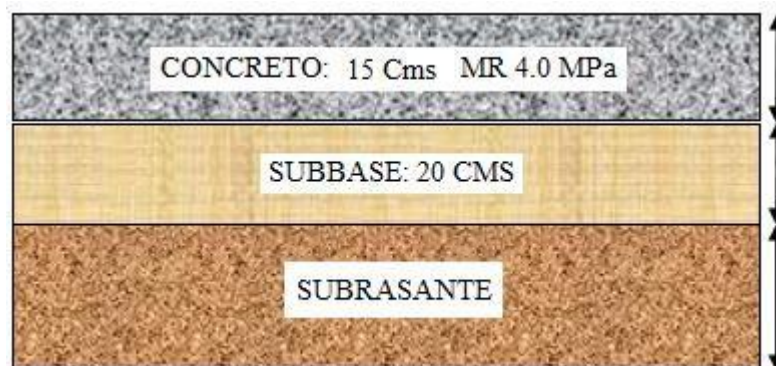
Estructura pavimento con un espesor de 15 cm y MR 4.0
